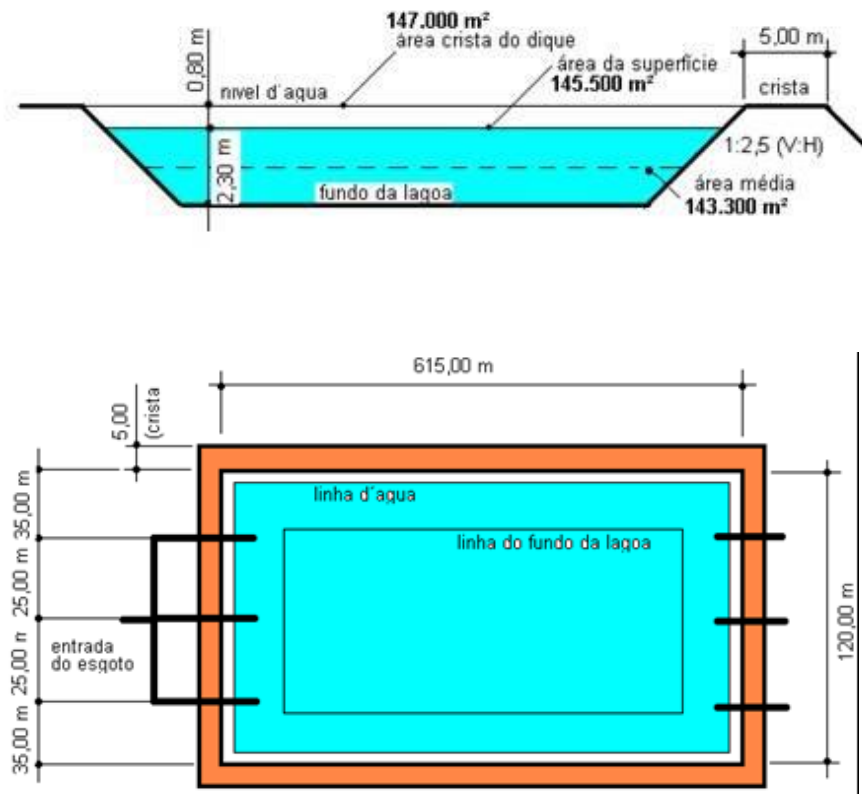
7: LAGOA FACULTATIVA – SEÇÃO VERTICAL E PLANTA (SEM ESCALA)
